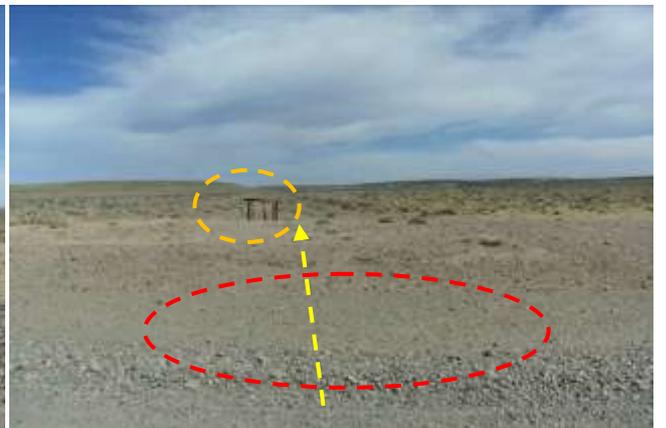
Emplazamiento de gasoducto Cruce con camino (rojo). Se observa protector de válvula (anaranjado). Foto en dirección SSE.
